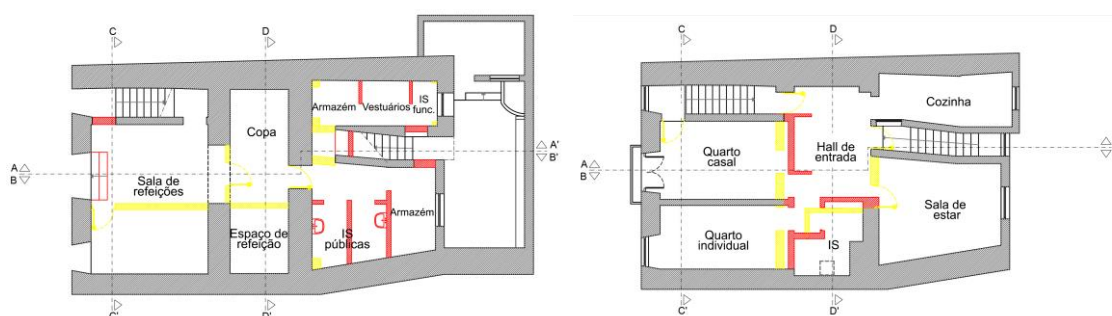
Planta de alterações, piso 0 e piso 1, respetivamente.
